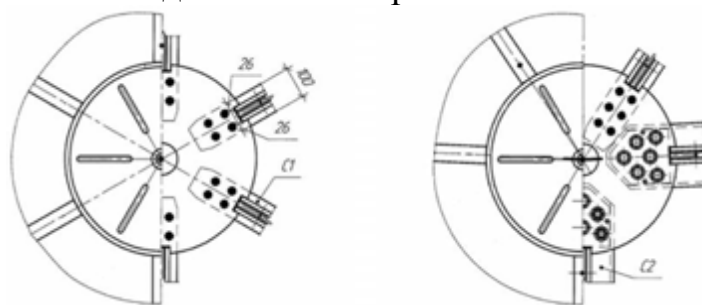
Узлы соединений каркаса алюминиевой кровли
